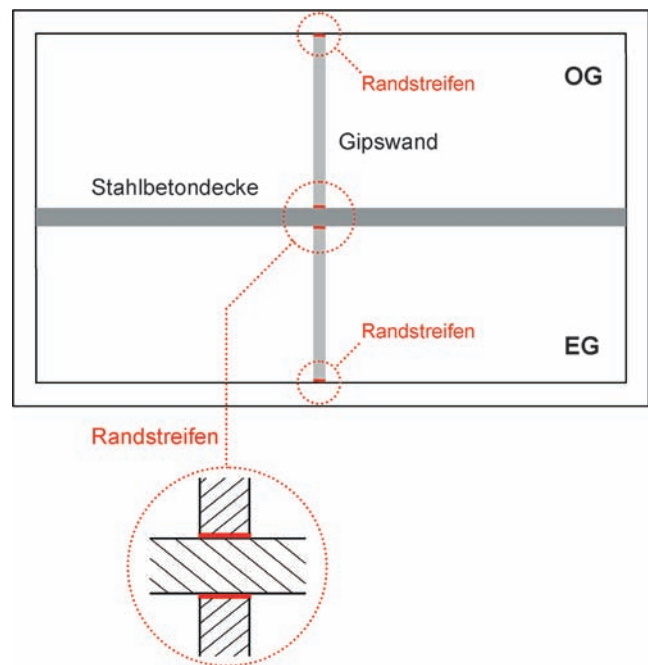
Schematische Darstellung (Schnitt) der vertikalen Übertragungssituation im Prüfstand mit durchlaufender Stahlbetondecke und flankierenden Gipswänden
